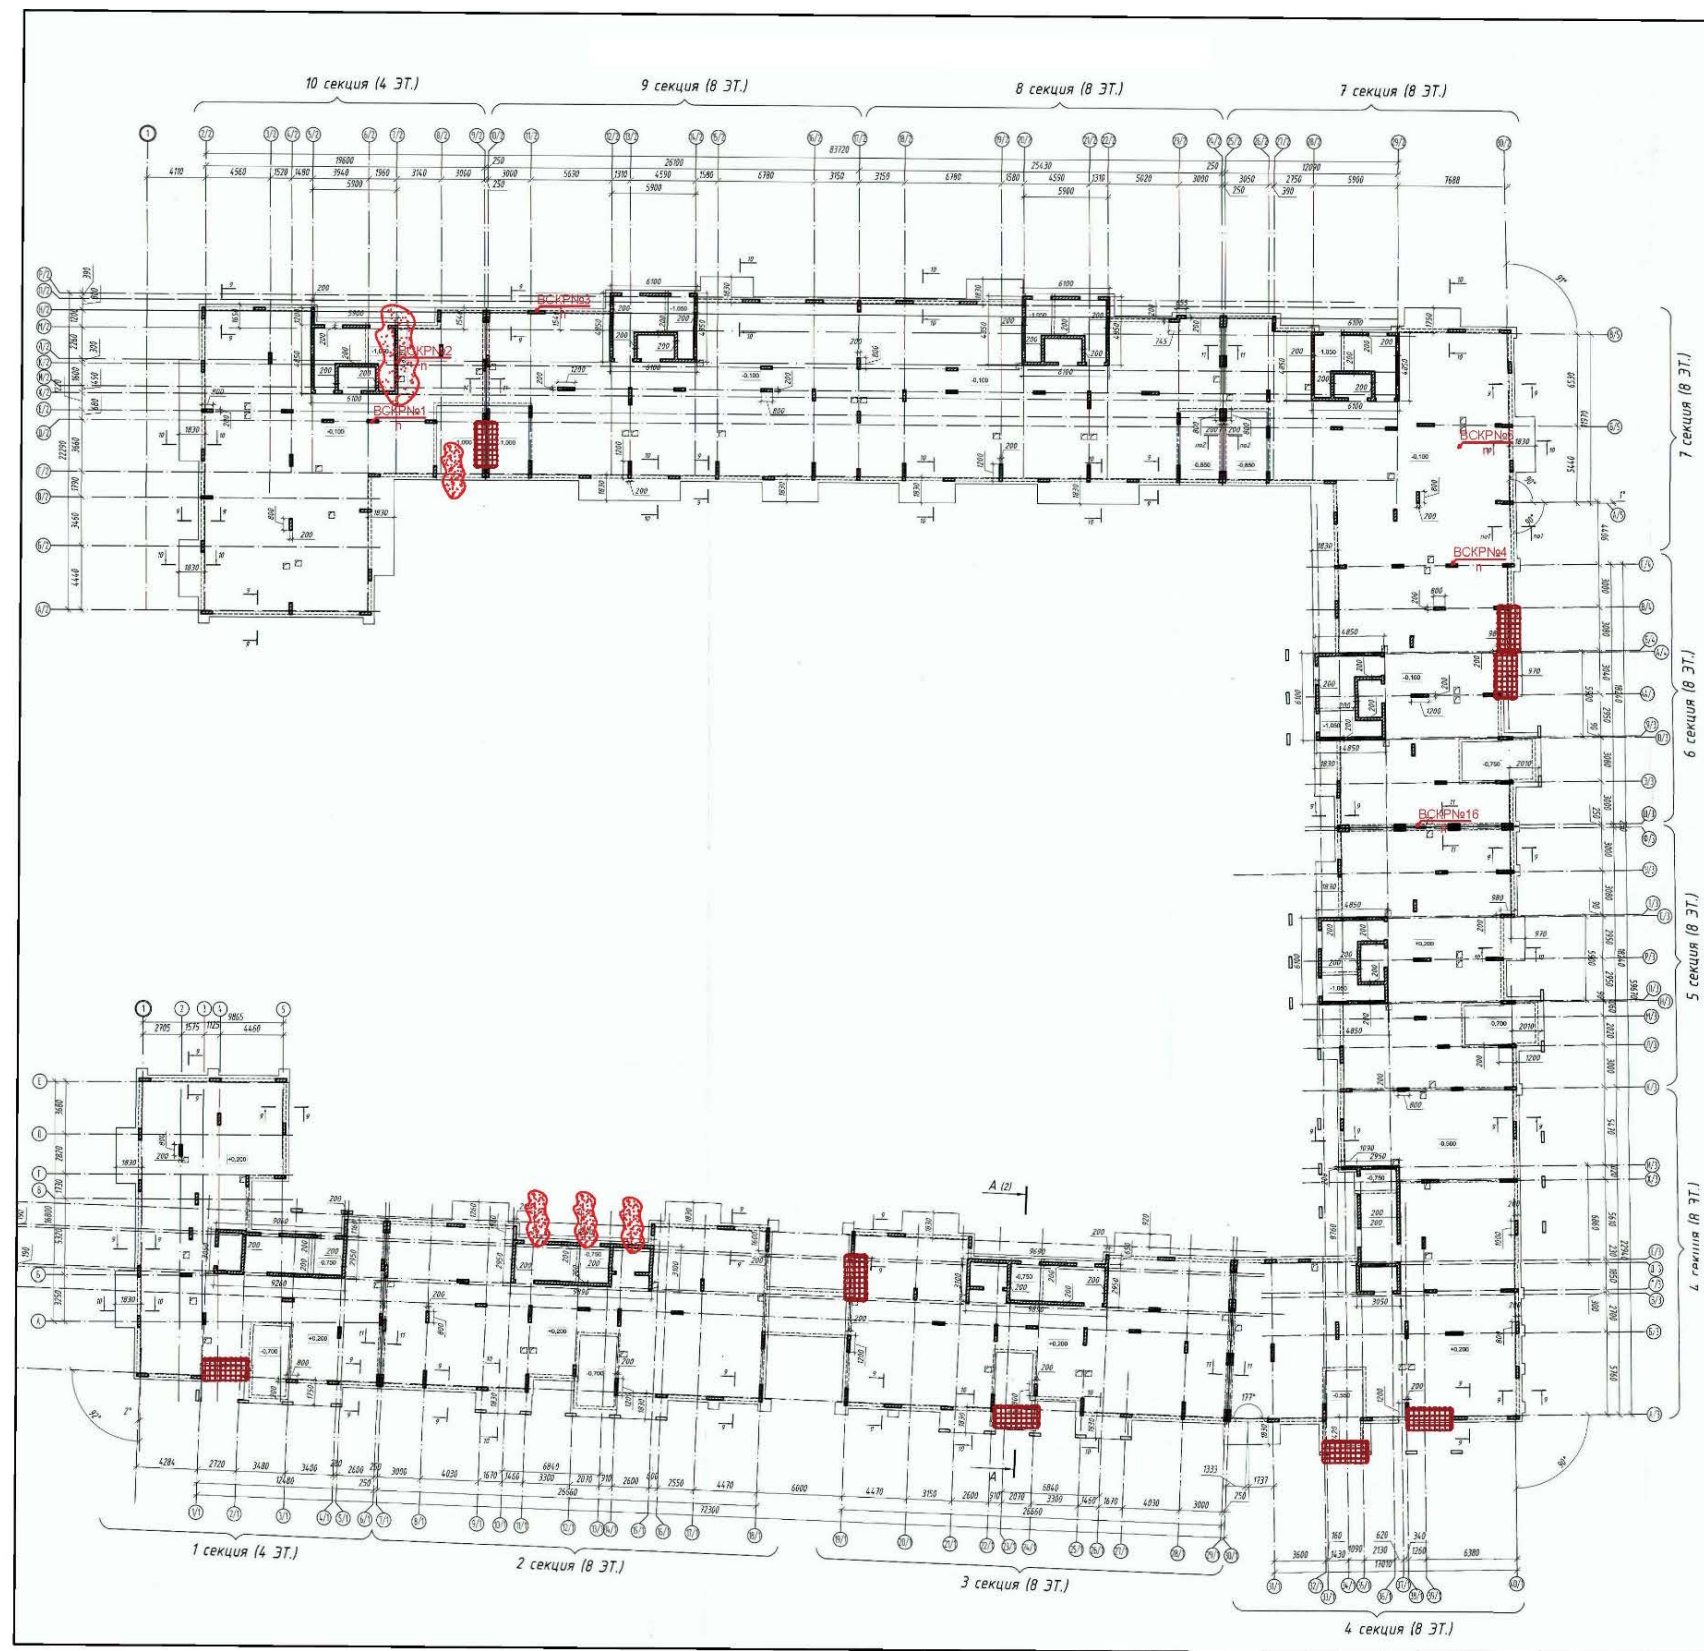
Карта дефектов верхней плоскости плиты перекрытия подвального этажа и вертикальных конструкций 1-го этажа
